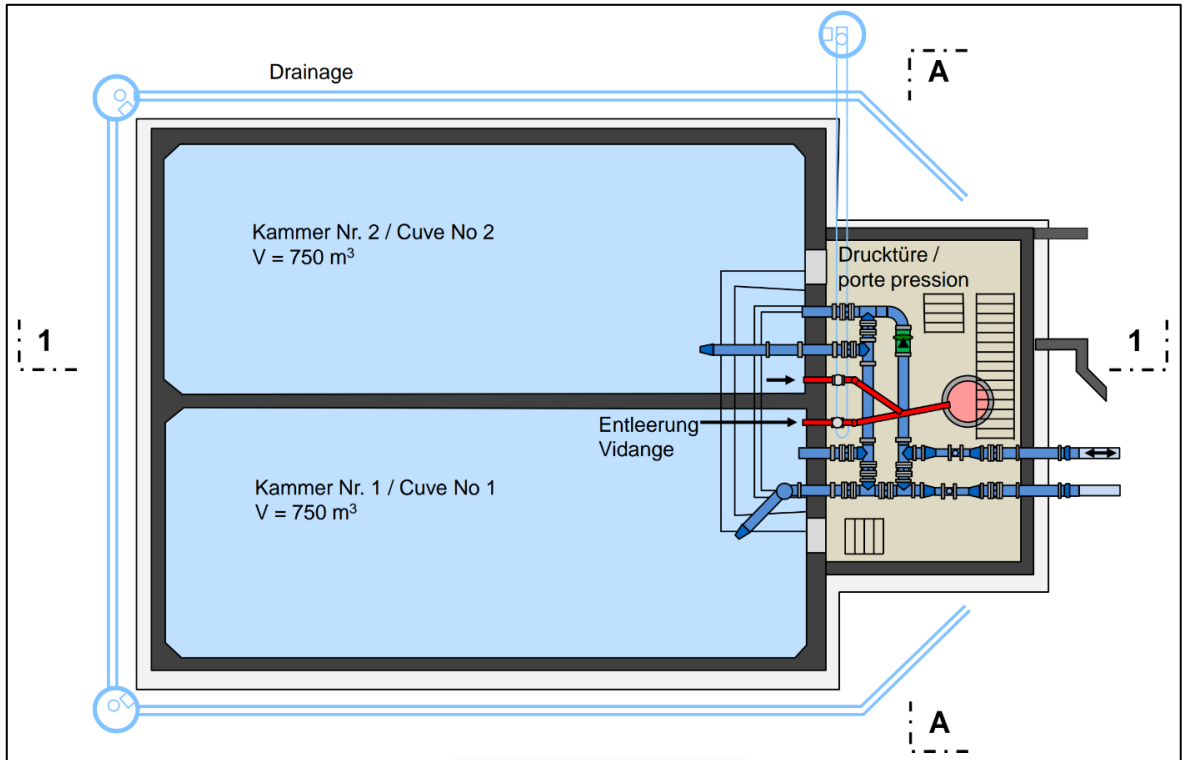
Beispiel eines Reservoirs, Grundriss
